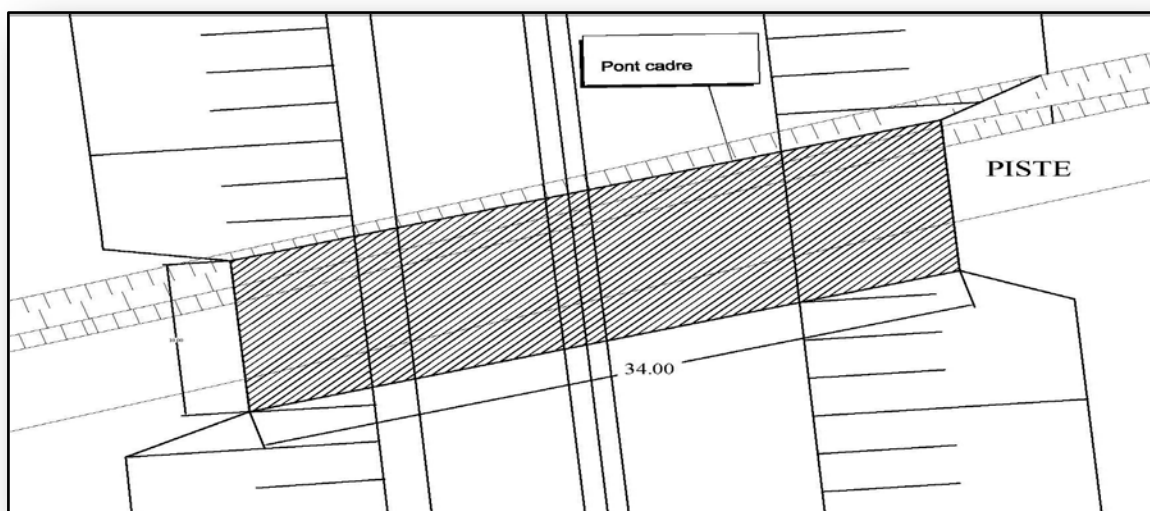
Vue en plan de l'ouvrage.
